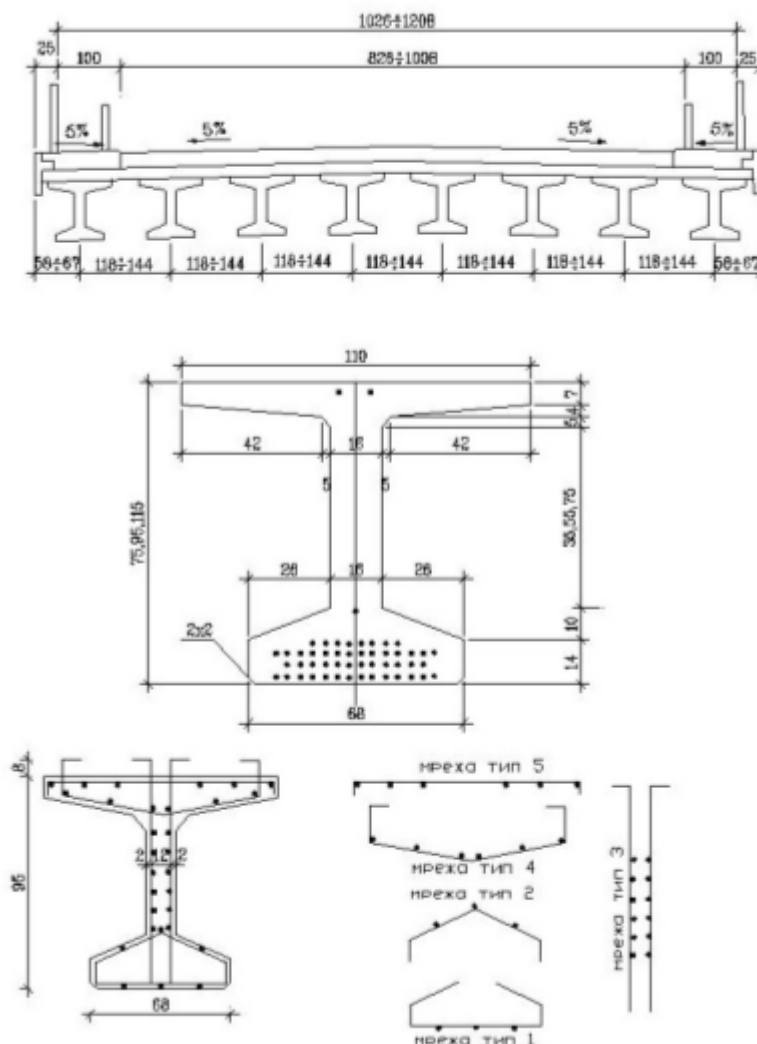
Сглобяема конструкция от Т-греди със широк горен пояс и монолитна плоча
